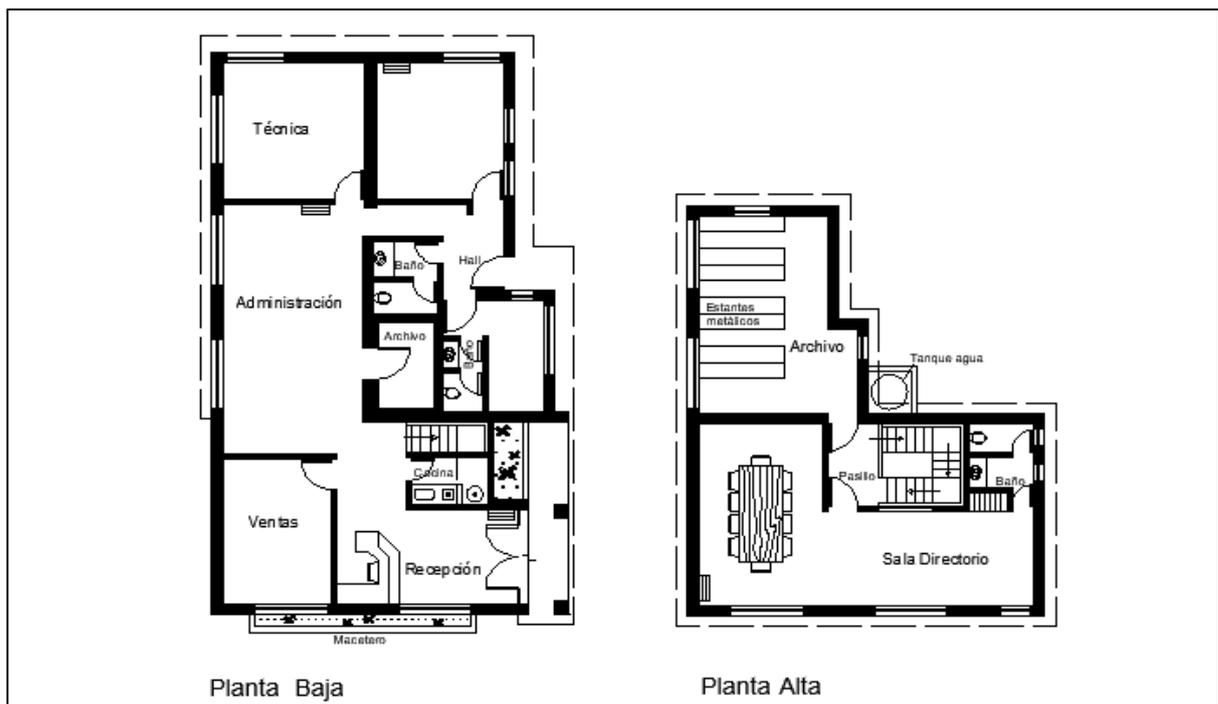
Plano de Planta Baja y Alta del sector.
